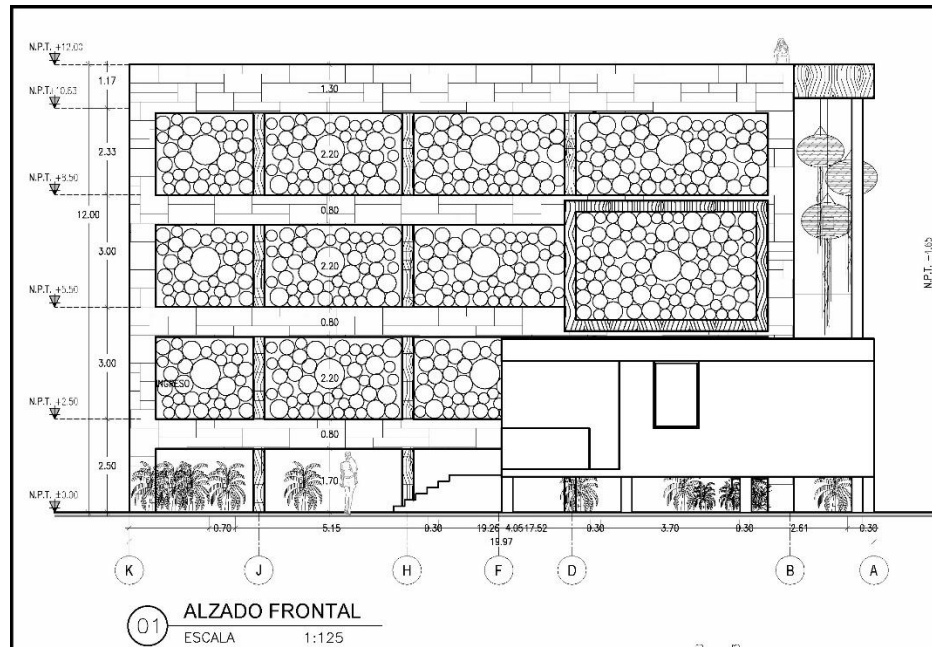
Alzado frontal del proyecto. En primer plano se puede apreciar la recepción y al fondo el edificio de tres niveles, con una altura máxima de 12 m, construido sobre palafitos.
